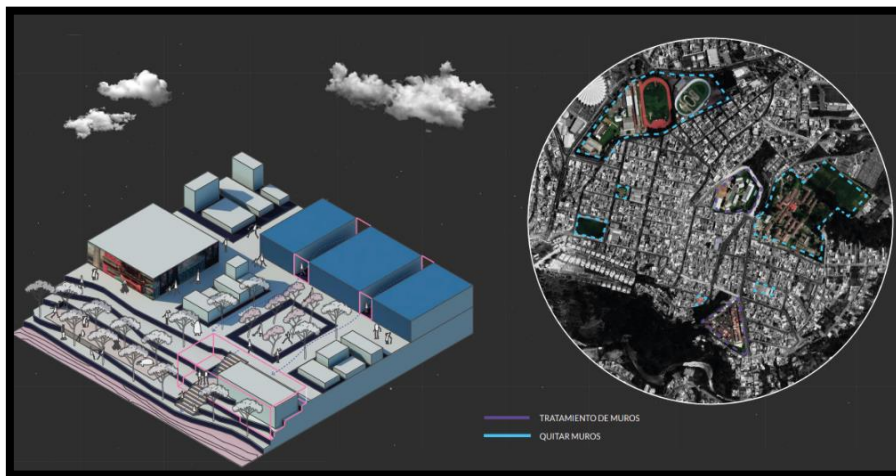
Tratamiento de Muros Scacco Ramires 2022
